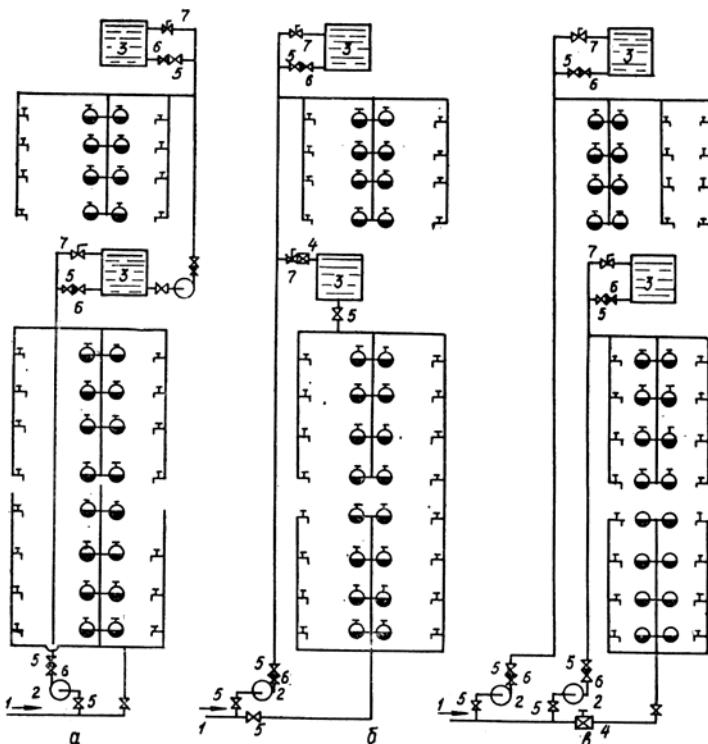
Схемы зонного водоснабжения многоэтажных зданий подачи воды:
